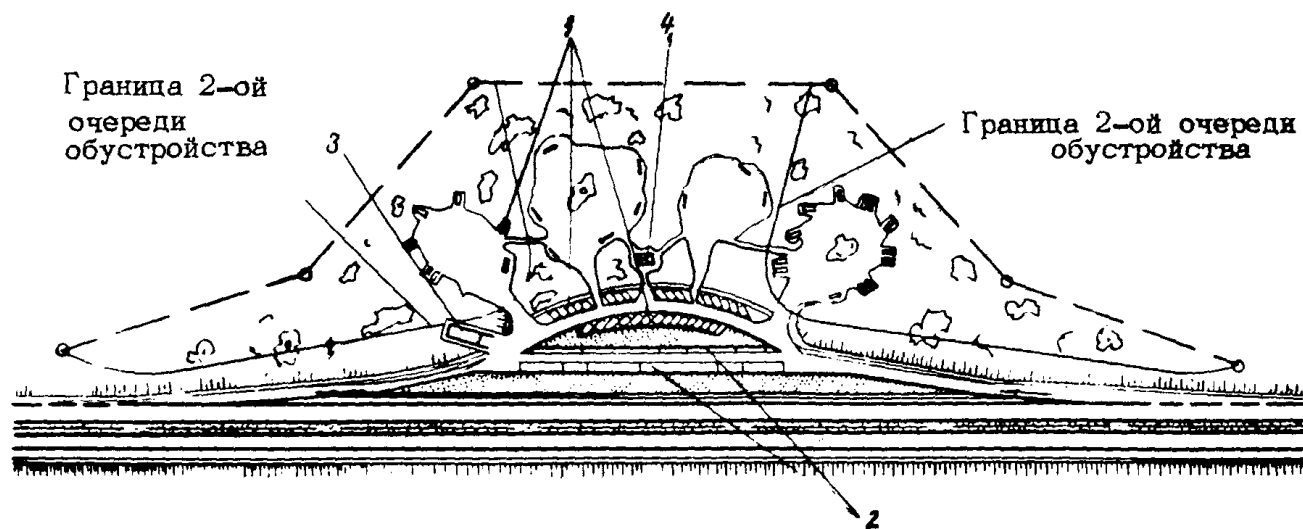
Схема площадки для стоянок на перегоне (французский вариант).
